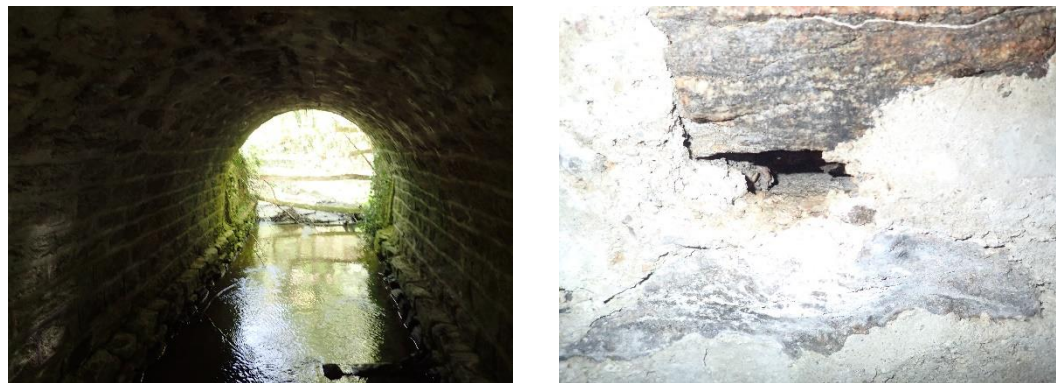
Ouvrage hydraulique situé au niveau du Verdier
